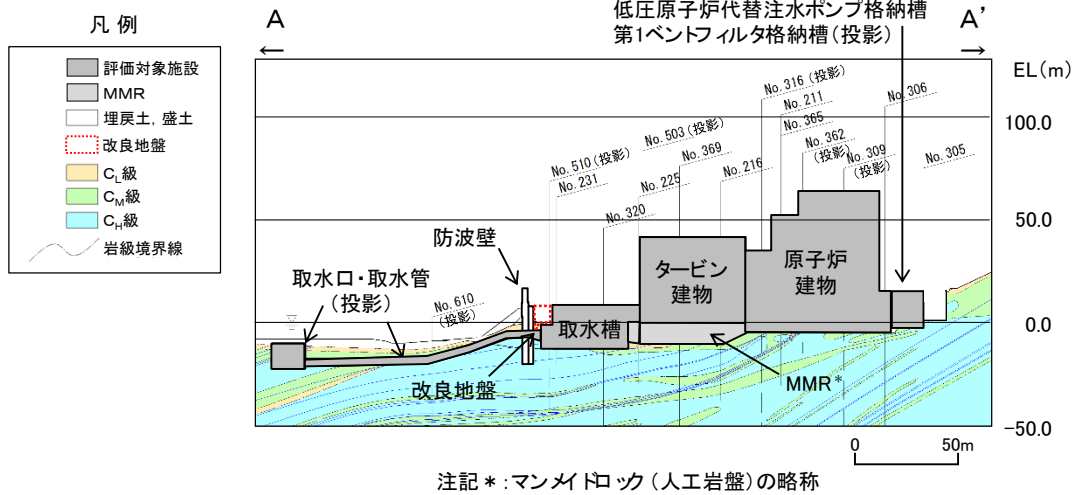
原子炉建物等の地質断面図 (A-A' 断面)
